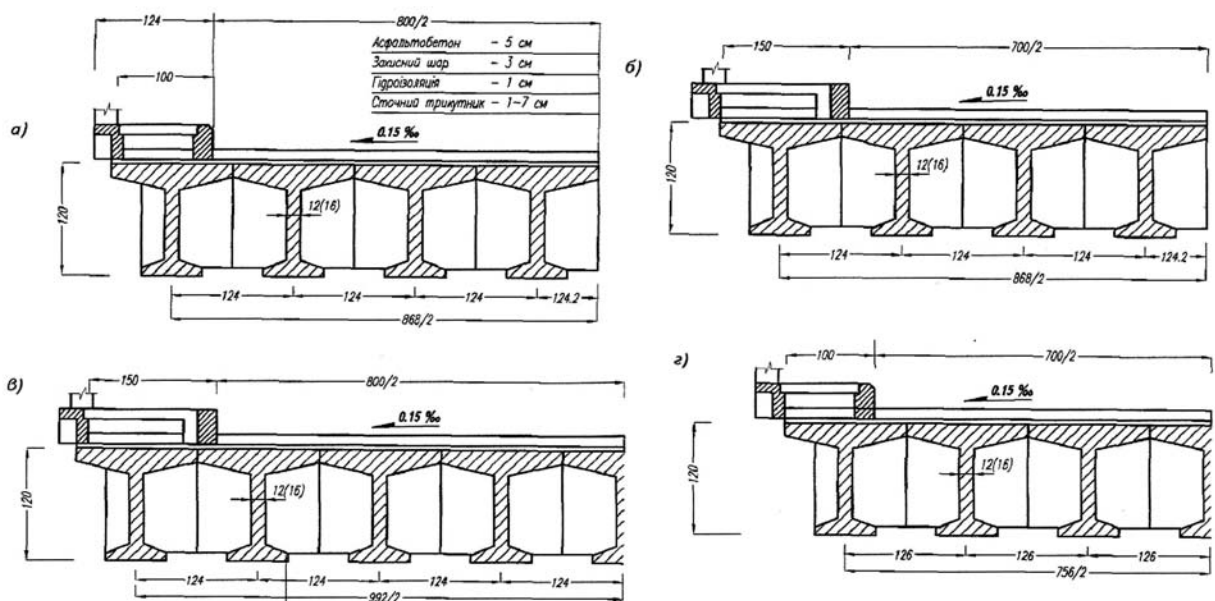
Типові поперечні перерізи струнобетонних прольотних будов $l=22,16$ м
